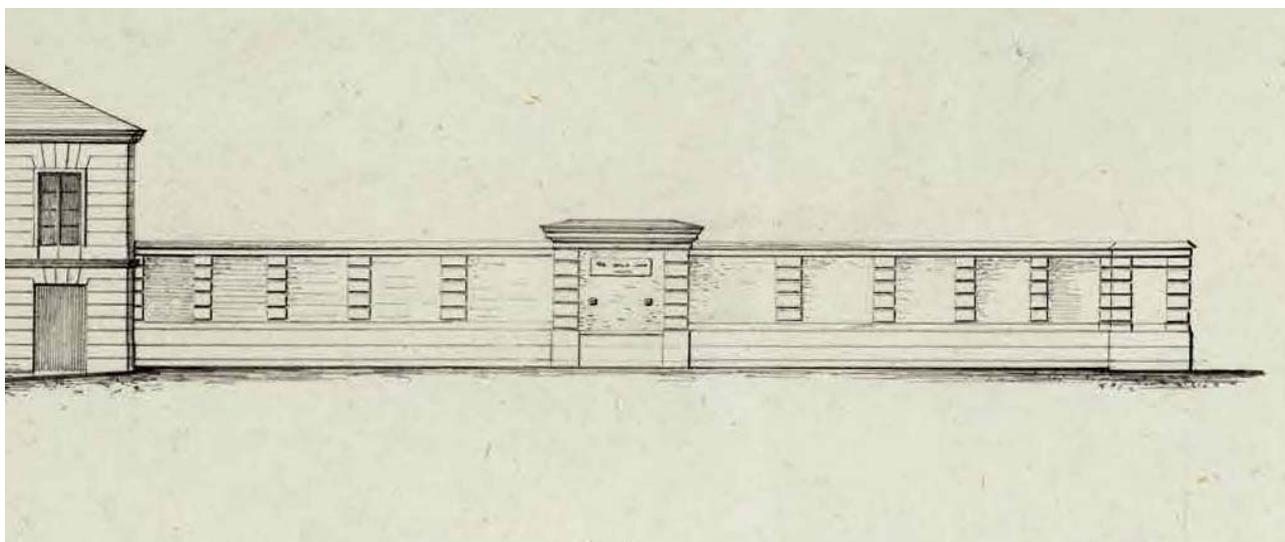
Detalle del plano anterior con el alzado de la Fuente de Luchana hacia el Paseo homónimo, con el muro que la respaldaba.
